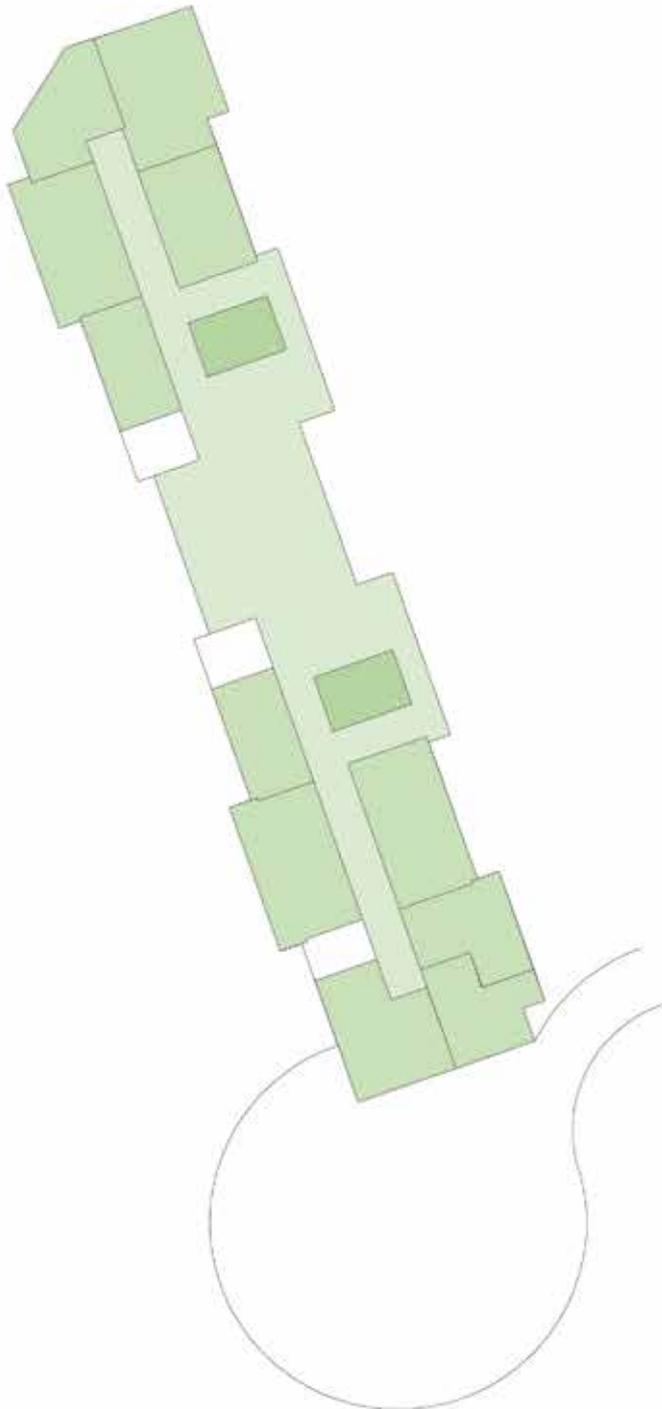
Übersichtsplan und Grundriss M 1:500
